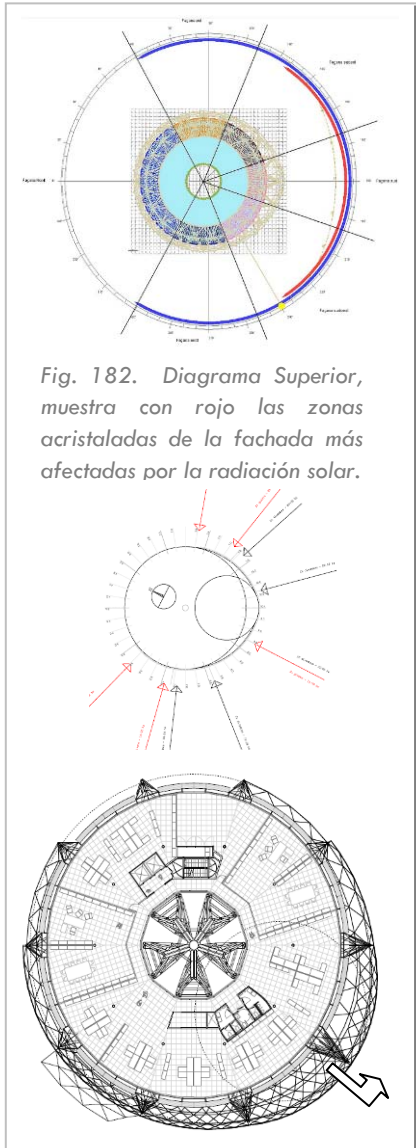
Diagrama Superior, muestra con rojo las zonas acristaladas de la fachada más afectadas por la radiación solar.
